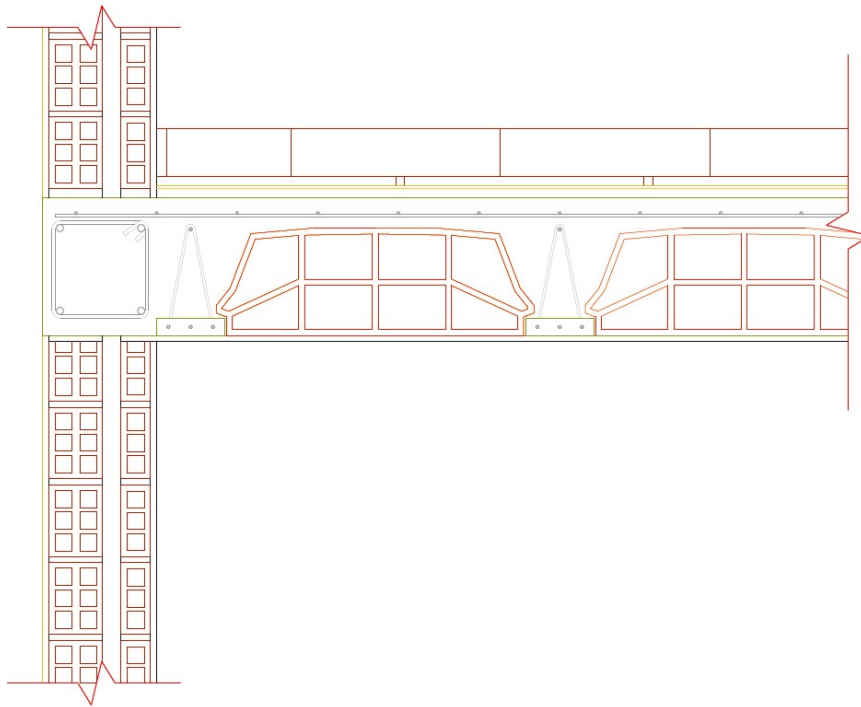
Detalle muro medianero actual, (Fuente: autor). * ver plano nº 9
